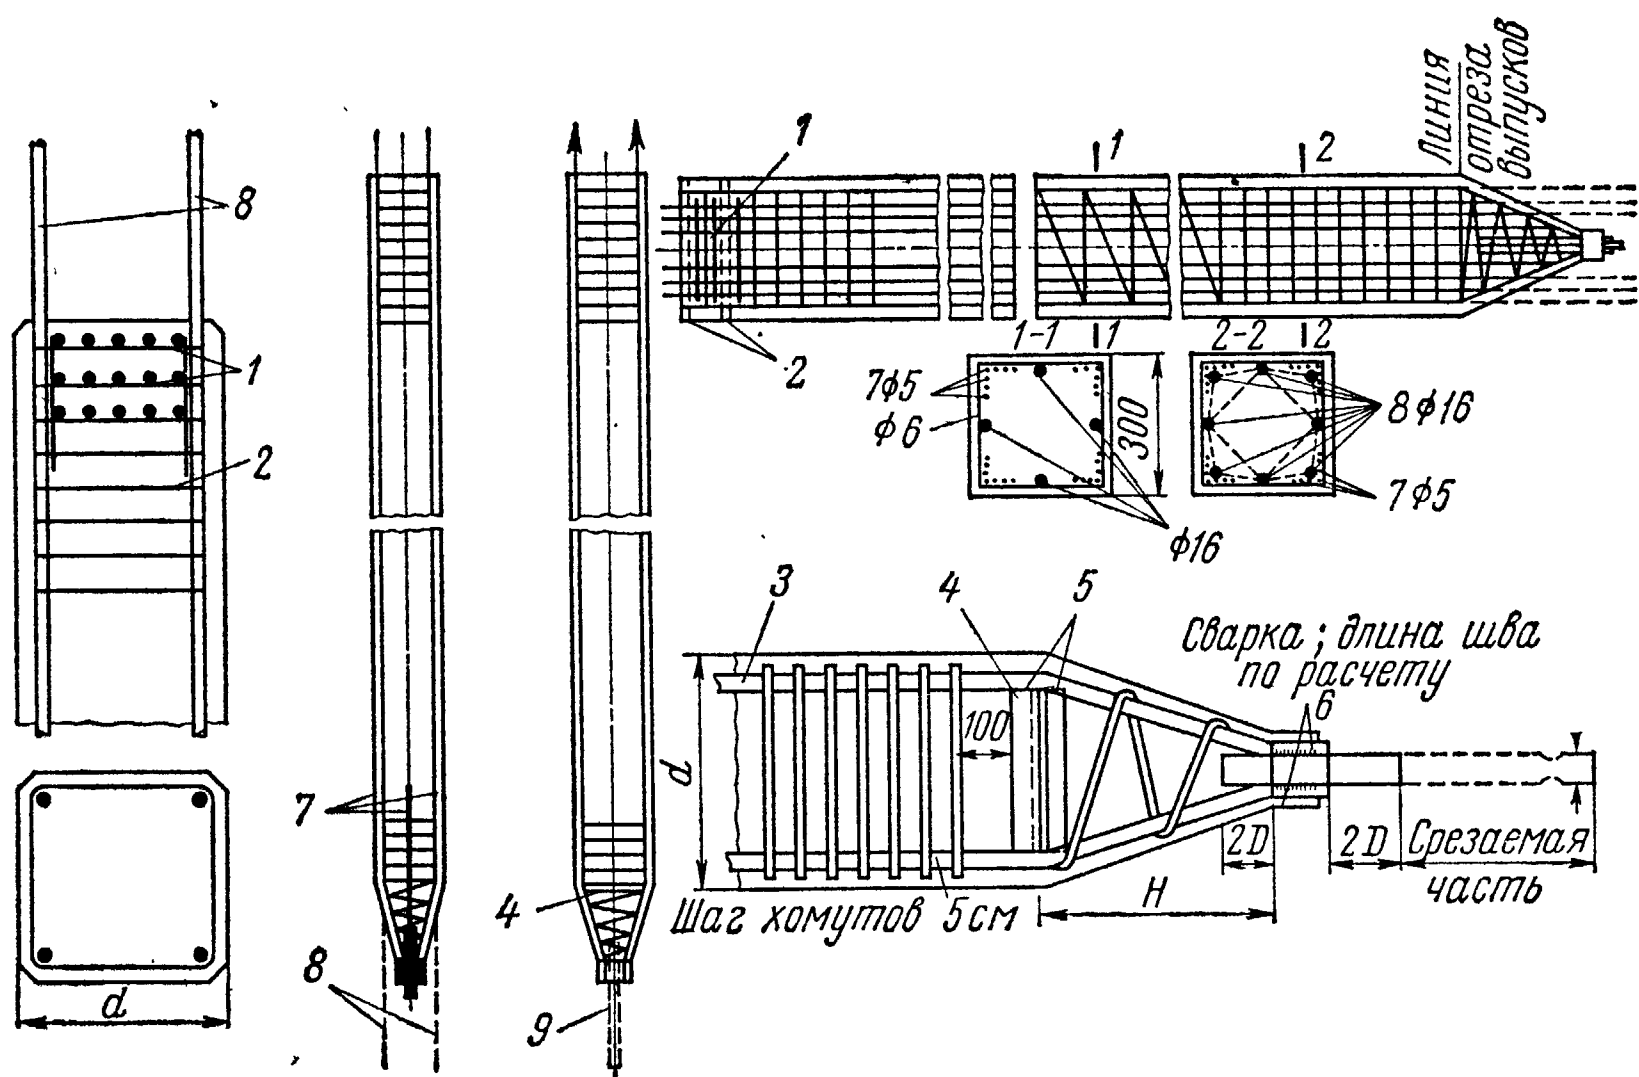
Конструкции выпускной арматуры в сваях с предварительным напряжением арматуры:
